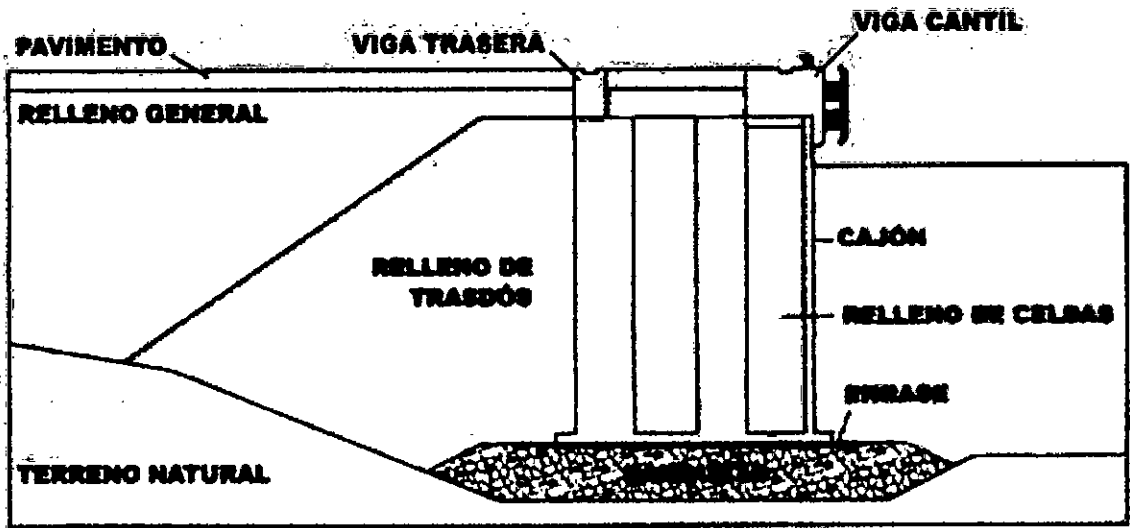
Sección. Muelle de gravedad de hormigón sumergido
